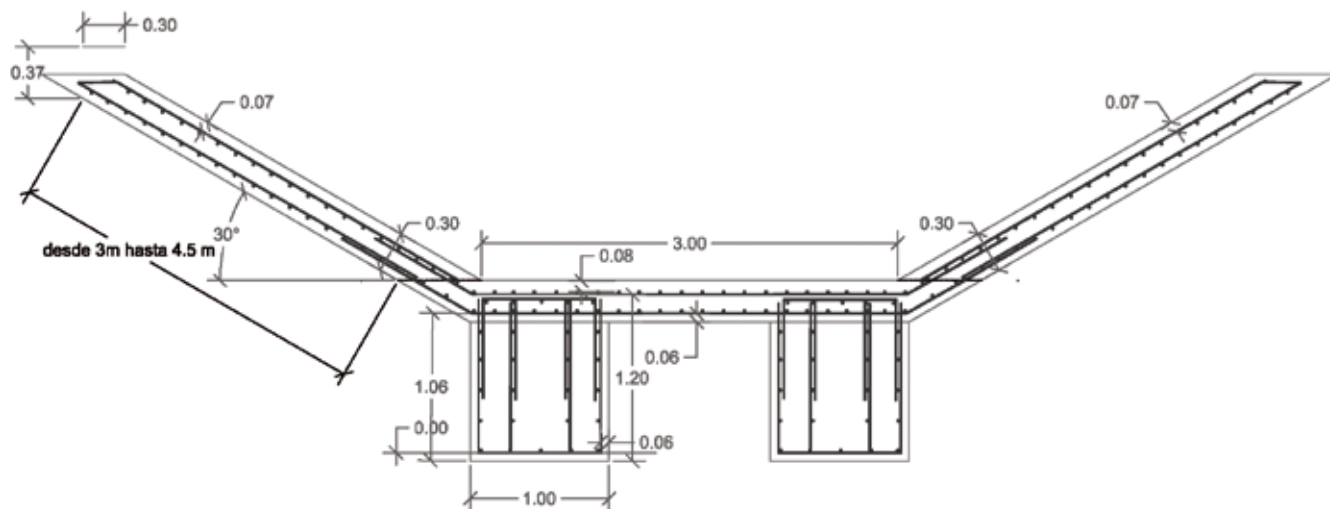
Sección transversal tipo de la estructura del canal. Durante la fase de obra, las dos vigas de fondo proyectadas originalmente fueron sustituidas por una única viga de anchura equivalente
